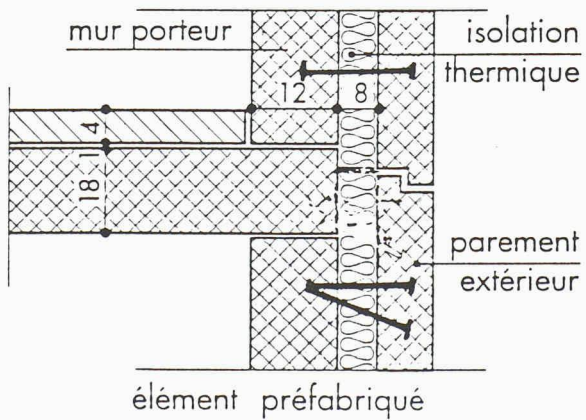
Coupe verticale d'un mur préfabriqué en béton
